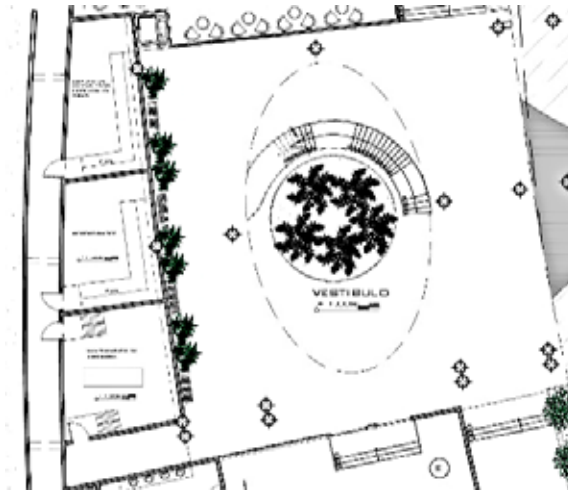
Planta baja, nivel +1.00m. Área de vestíbulo (2017).
